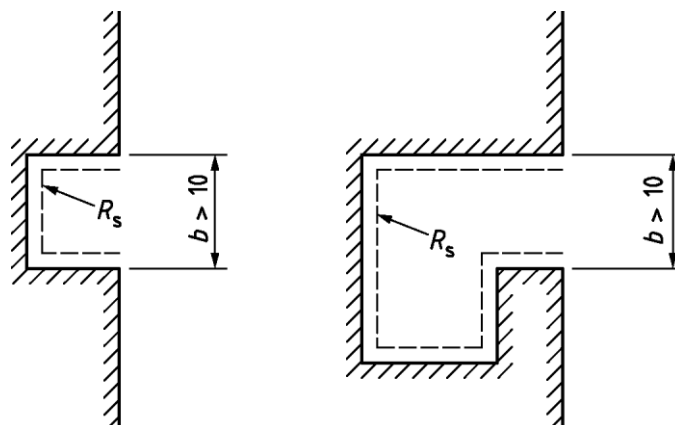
Exemplos para cavidades e ranhuras bem ventiladas
